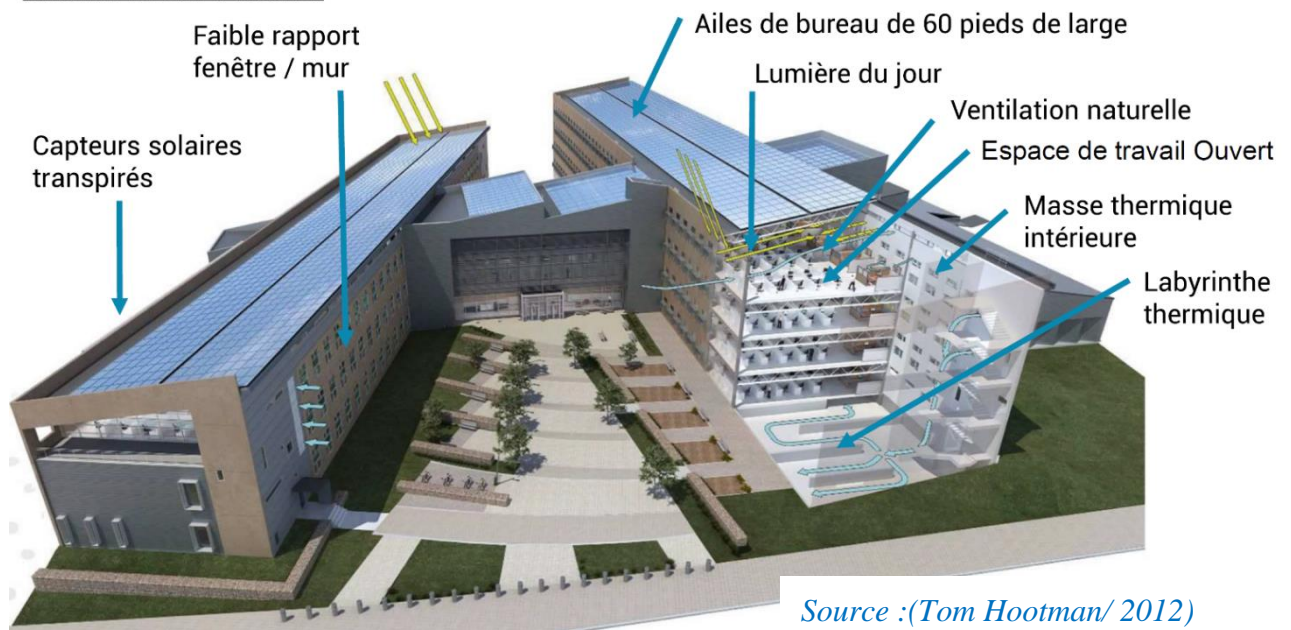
traitement de l'éclairage et la ventilation sur la façade sud dans le bâtiment RSF
